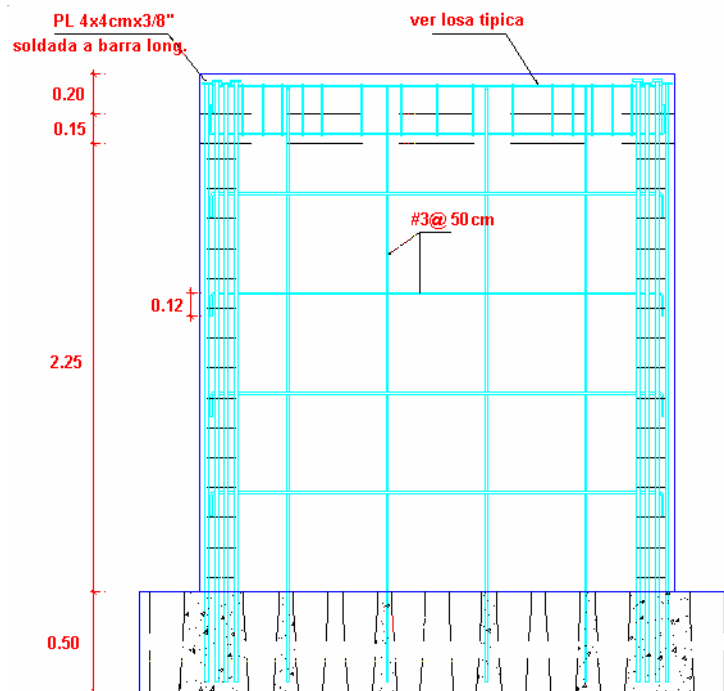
Detalles constructivos muro MCC50M y MCC50C
